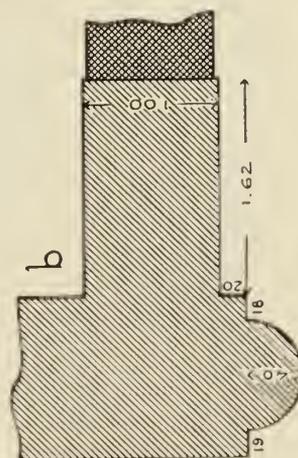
Boşrâ: Dêr Bahîrâ: Grundriß der nordwestlichen äußeren Ecke der Kirche (vgl. Fig. 914).
